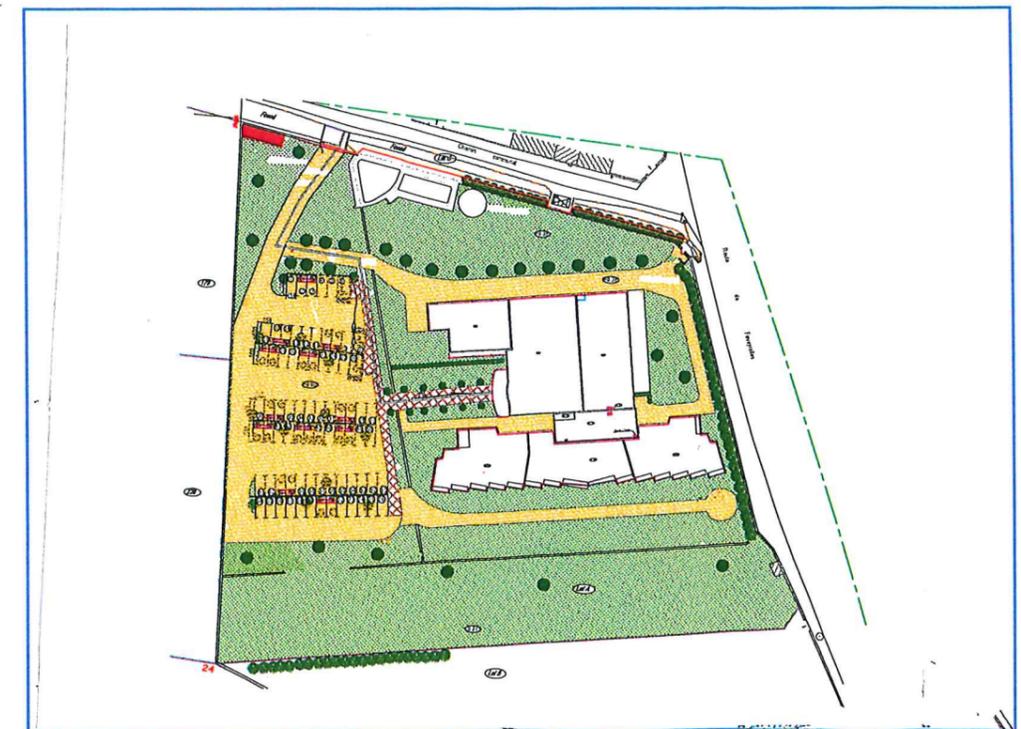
Plan de masse (source : SARL Millet Architecture)
